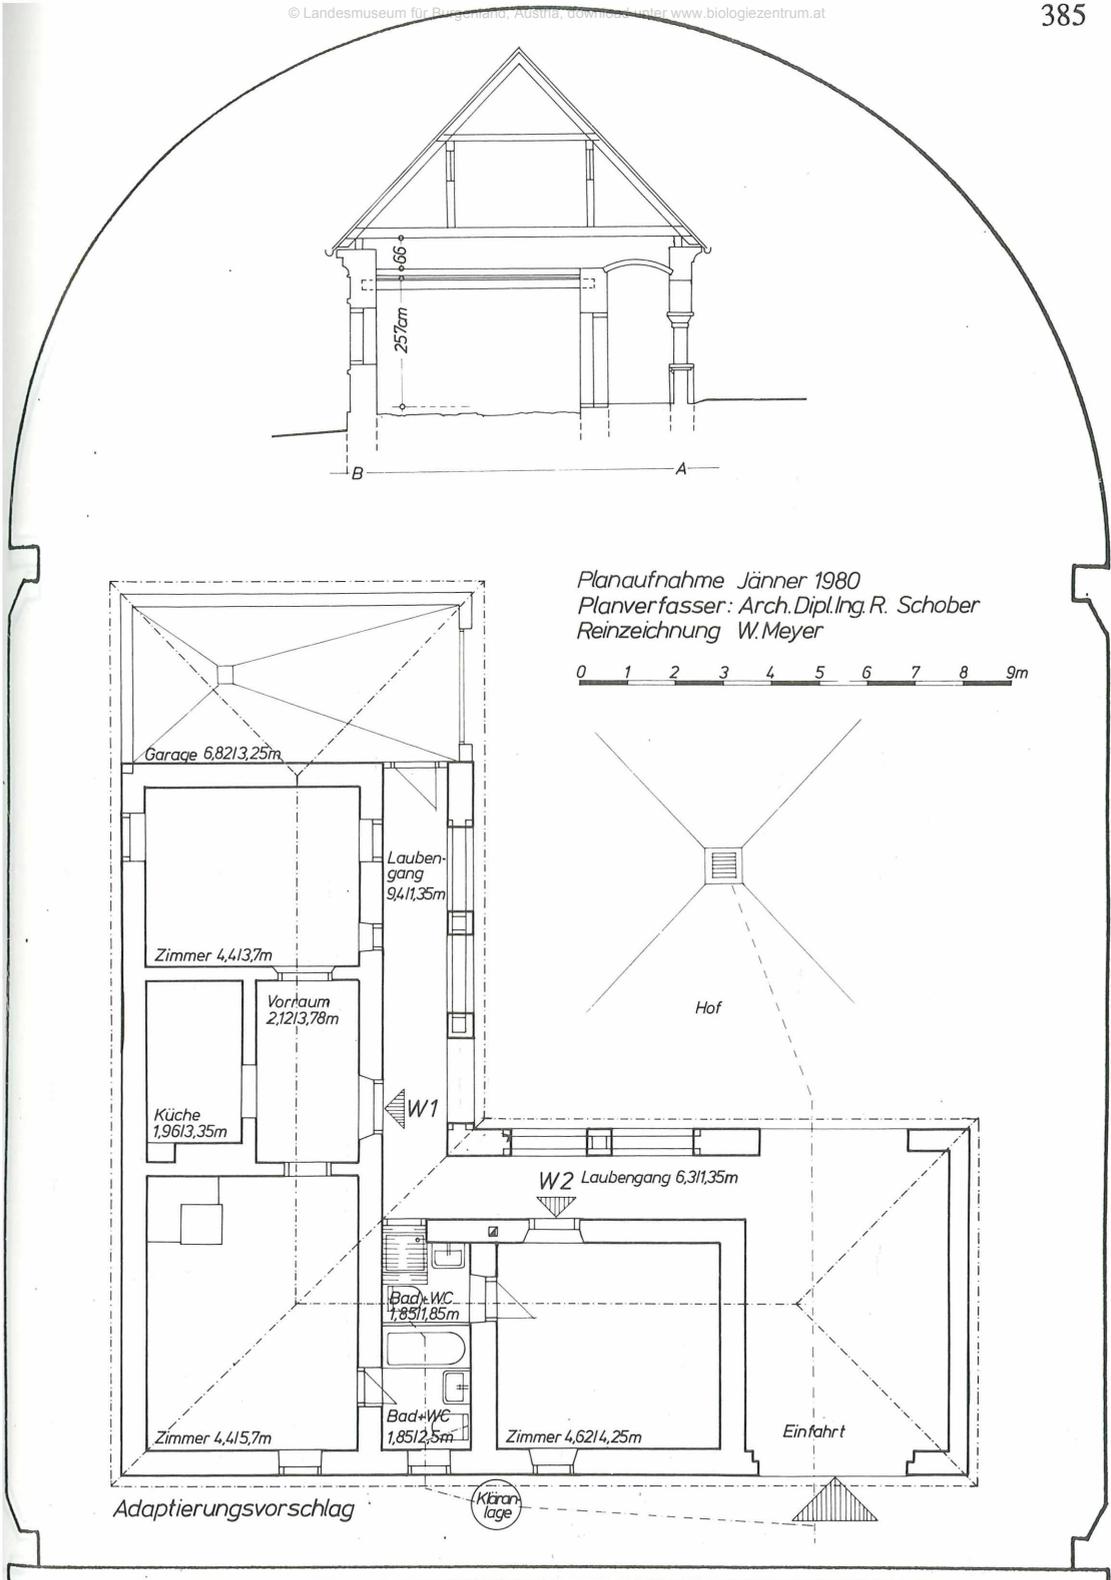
Buchschachen Nr. 124 - Schnitte, Details und Lageplan (Bgl. Landesmuseum, Kartensammlung)
